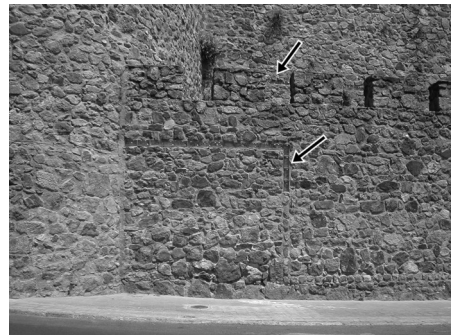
Proyecto Miranda. Zona Puerta de Trujillo. Foto Matesanz.
